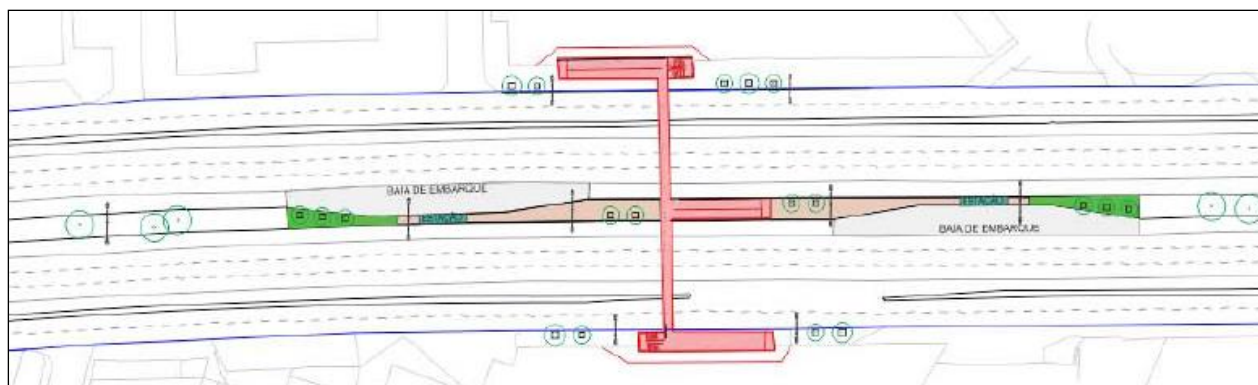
Planta Esquemática Plataforma - Fonte: SEINF
